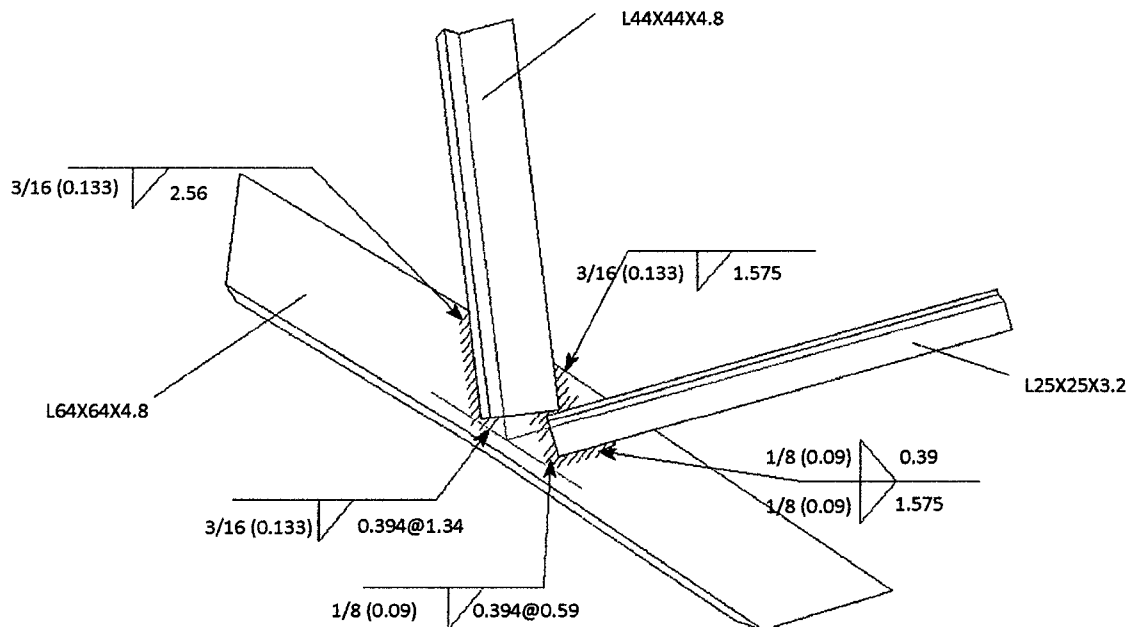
76: Detalle de Conexión en Viga VP-01.
